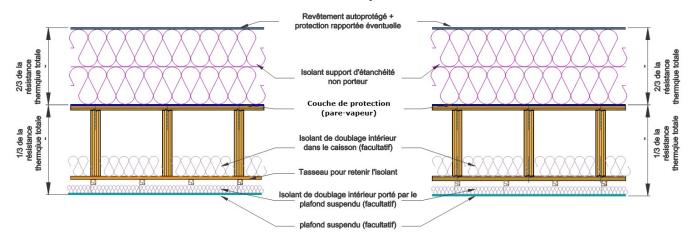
Toiture chaud isolée en toiture-terrasse accessible aux piétons (pente ≤ 5 % et ≥ 1,6 % ; 1,8 % ou 3 %)
